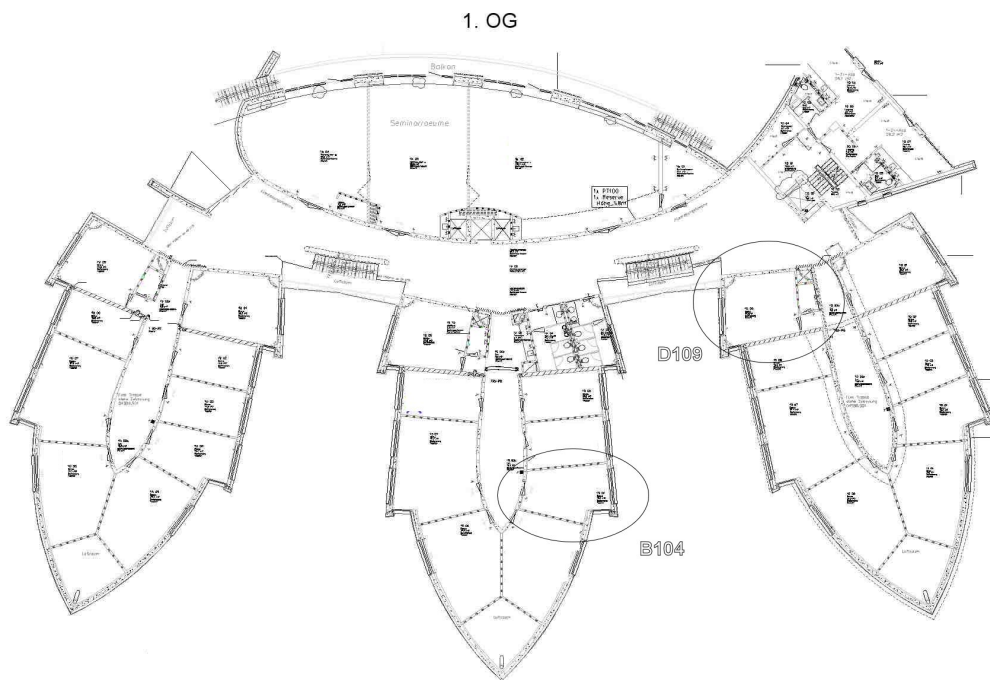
Grundriss des 1. OG des Artur-Woll-Hauses. In den markierten Büros wurden die Lichtmessungen durchgeführt.
